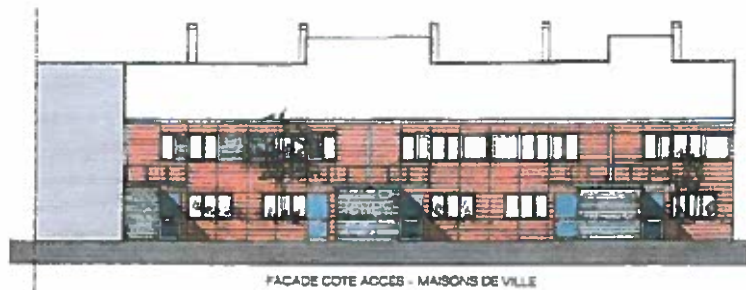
Façade des maisons de ville, architecte : A. Pessoa.
